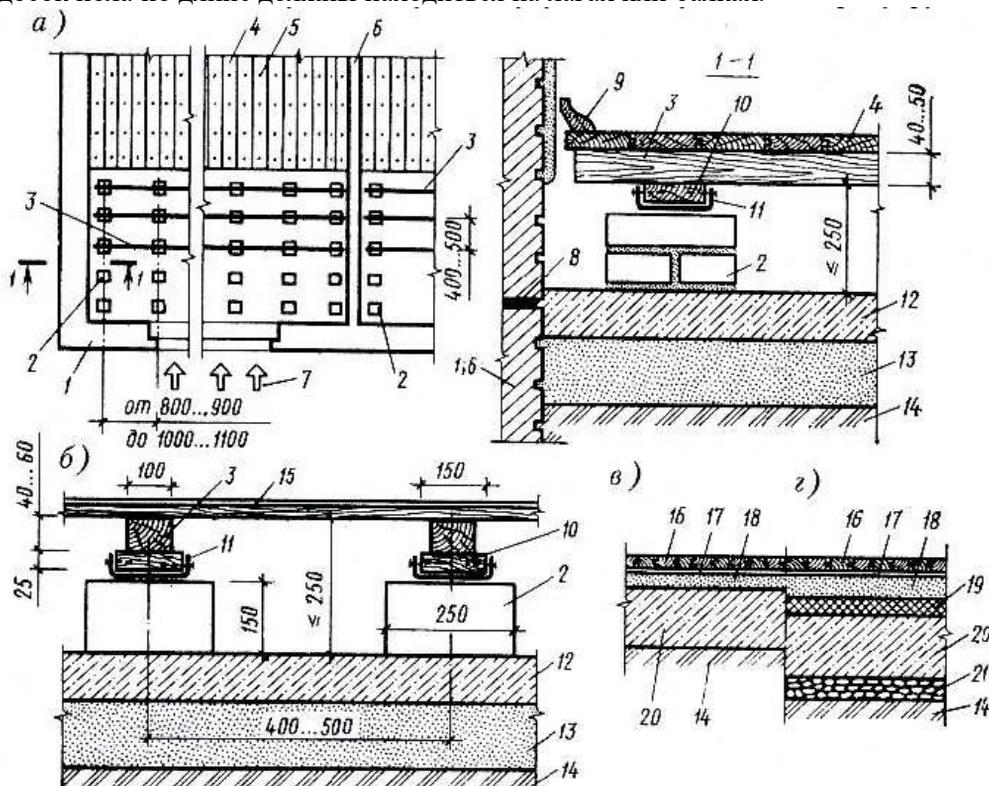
Конструкции полов первых этажей по лагам и на грунте:
